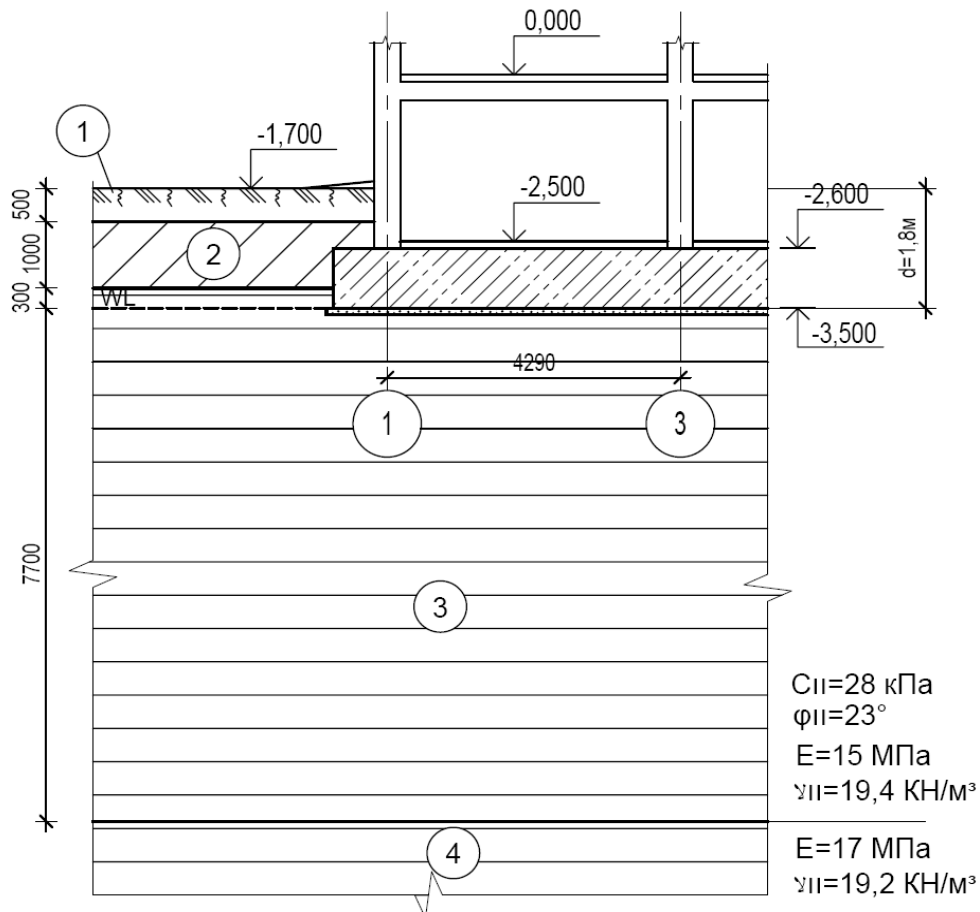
Положення плитного фундаменту у ґрунті
